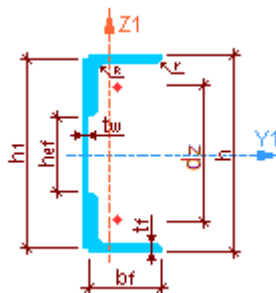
Схема профиля Швеллер сварной из листа и уголков
